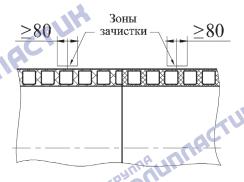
Механическая подготовка свариваемых поверхностей труб
